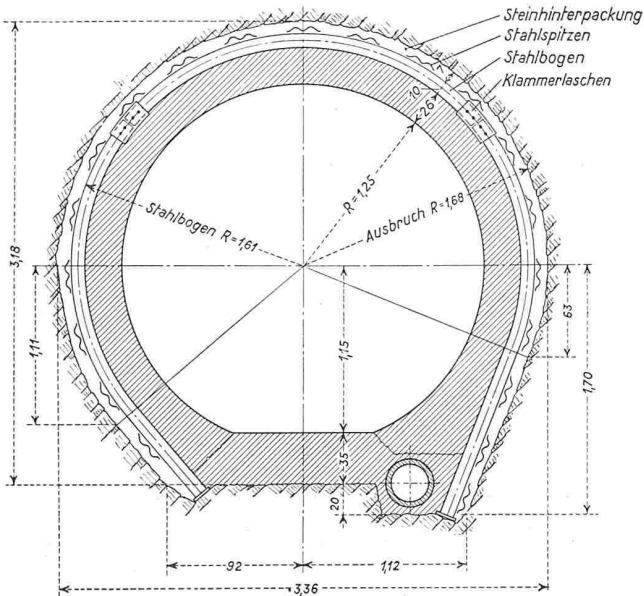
Stahleinbau ohne Sohlschwelle, Verzug mit Stahlbrettern (Spitzen). Masstab 1 : 50
